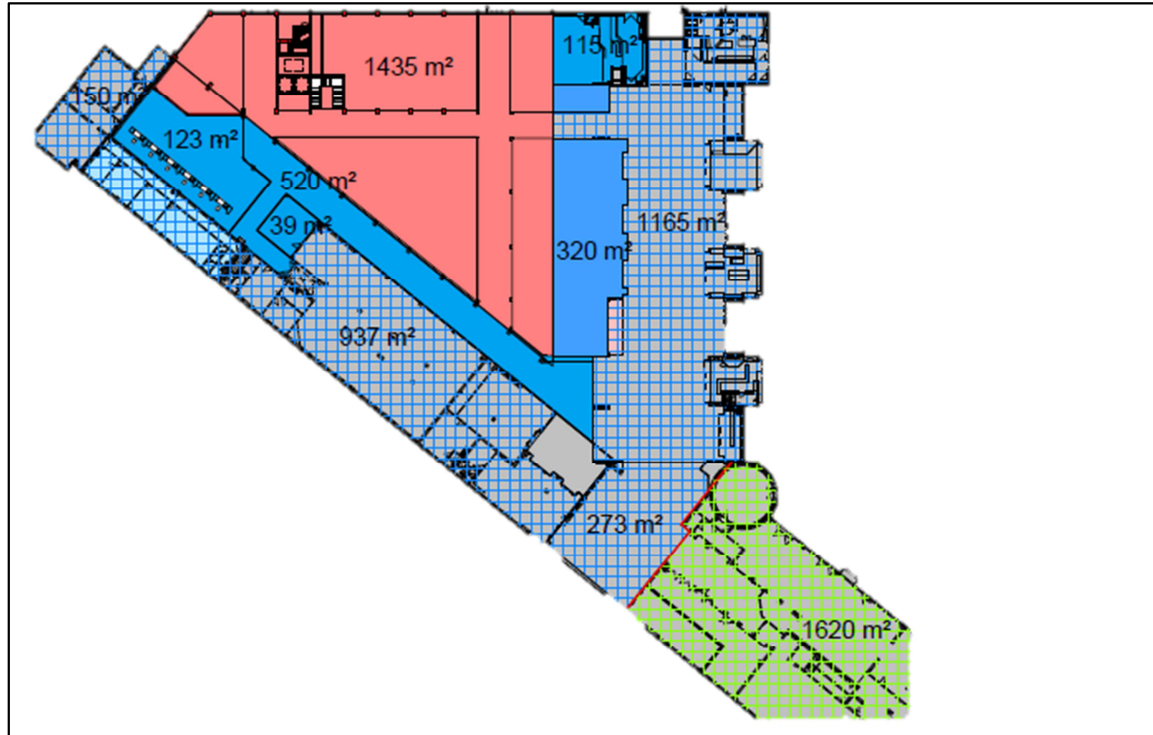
Grundriss Erdgeschoss incl. geplantem Neubau
